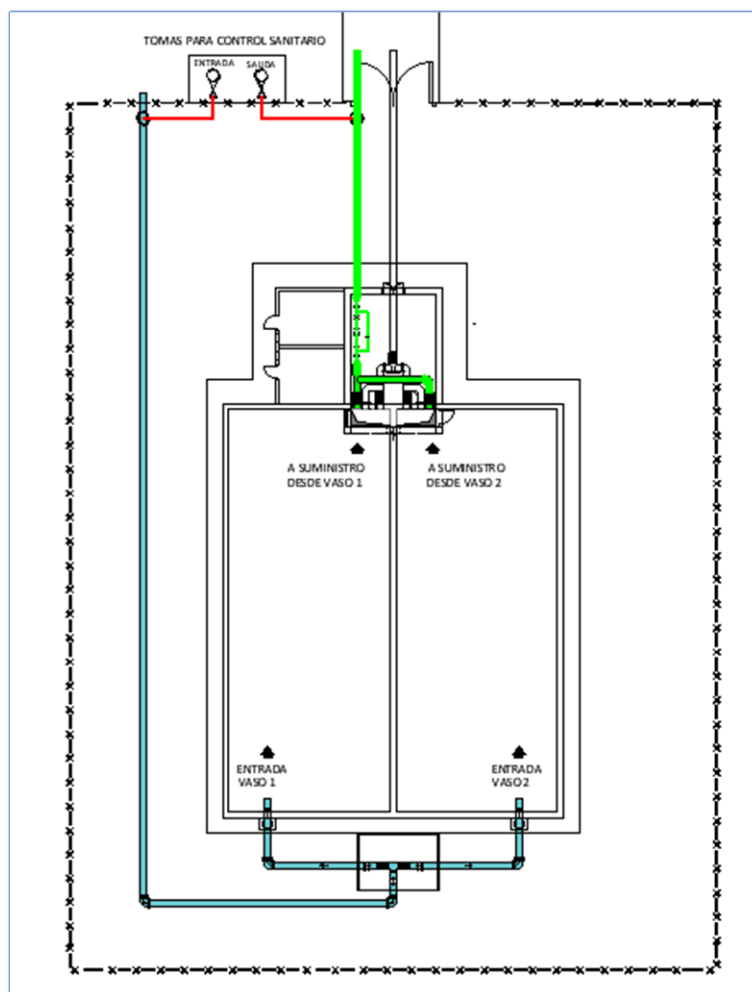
Ejemplo disposición de tuberías de entrada (azul) y salida (verde) de las cámaras o vasos
